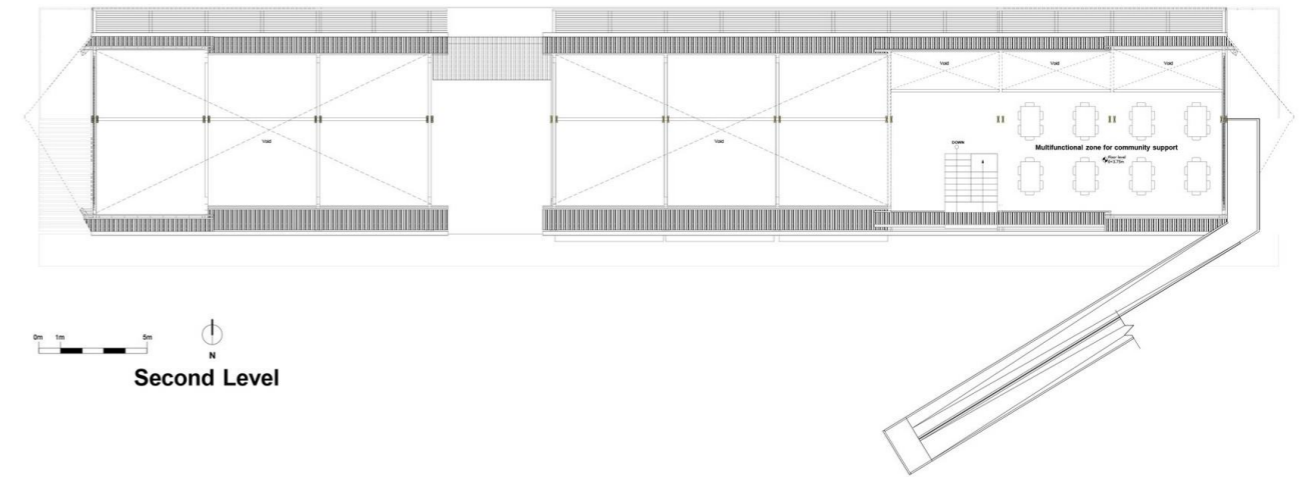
Planta de distribución del segundo nivel (mezanine), fuente: Archdaily.com, 2014
